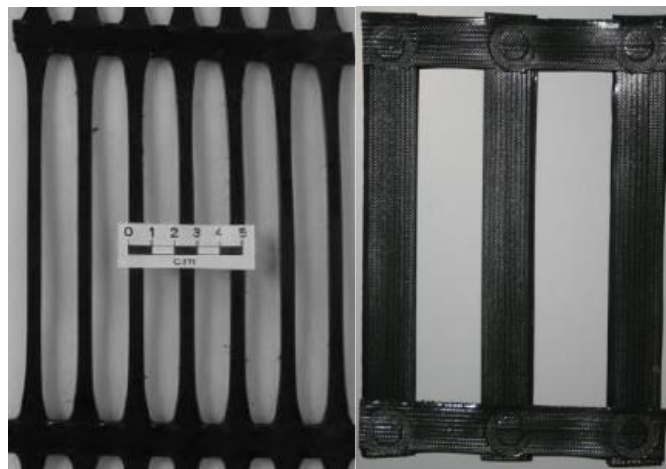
Geomalla uniaxial extruida y soldada
